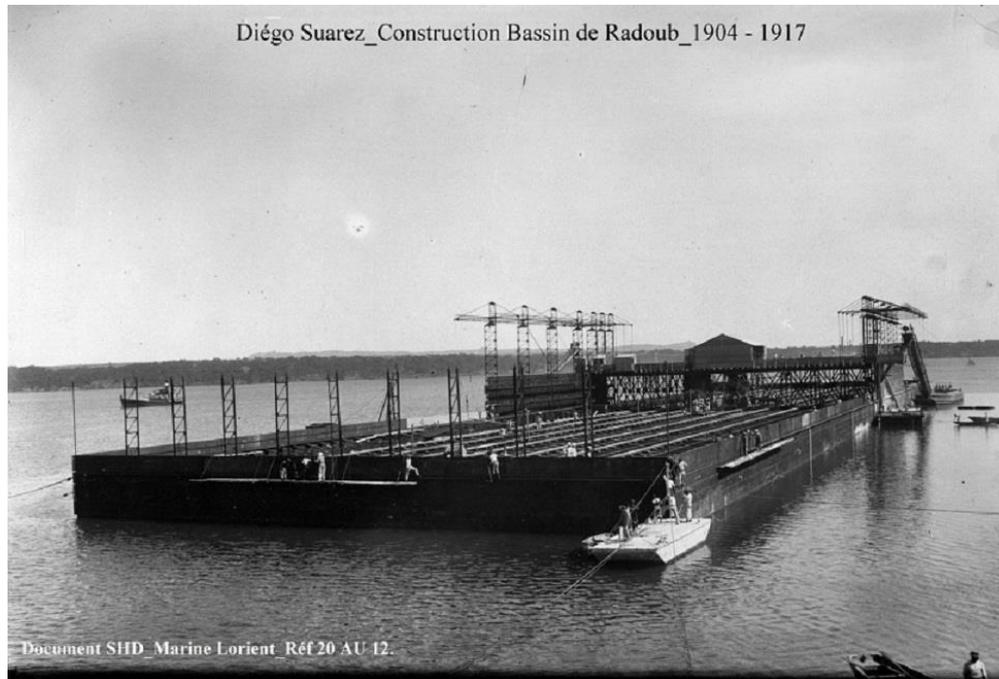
Construction à flot des caissons latéraux et des bajoyers (Archives SHD Lorient)
